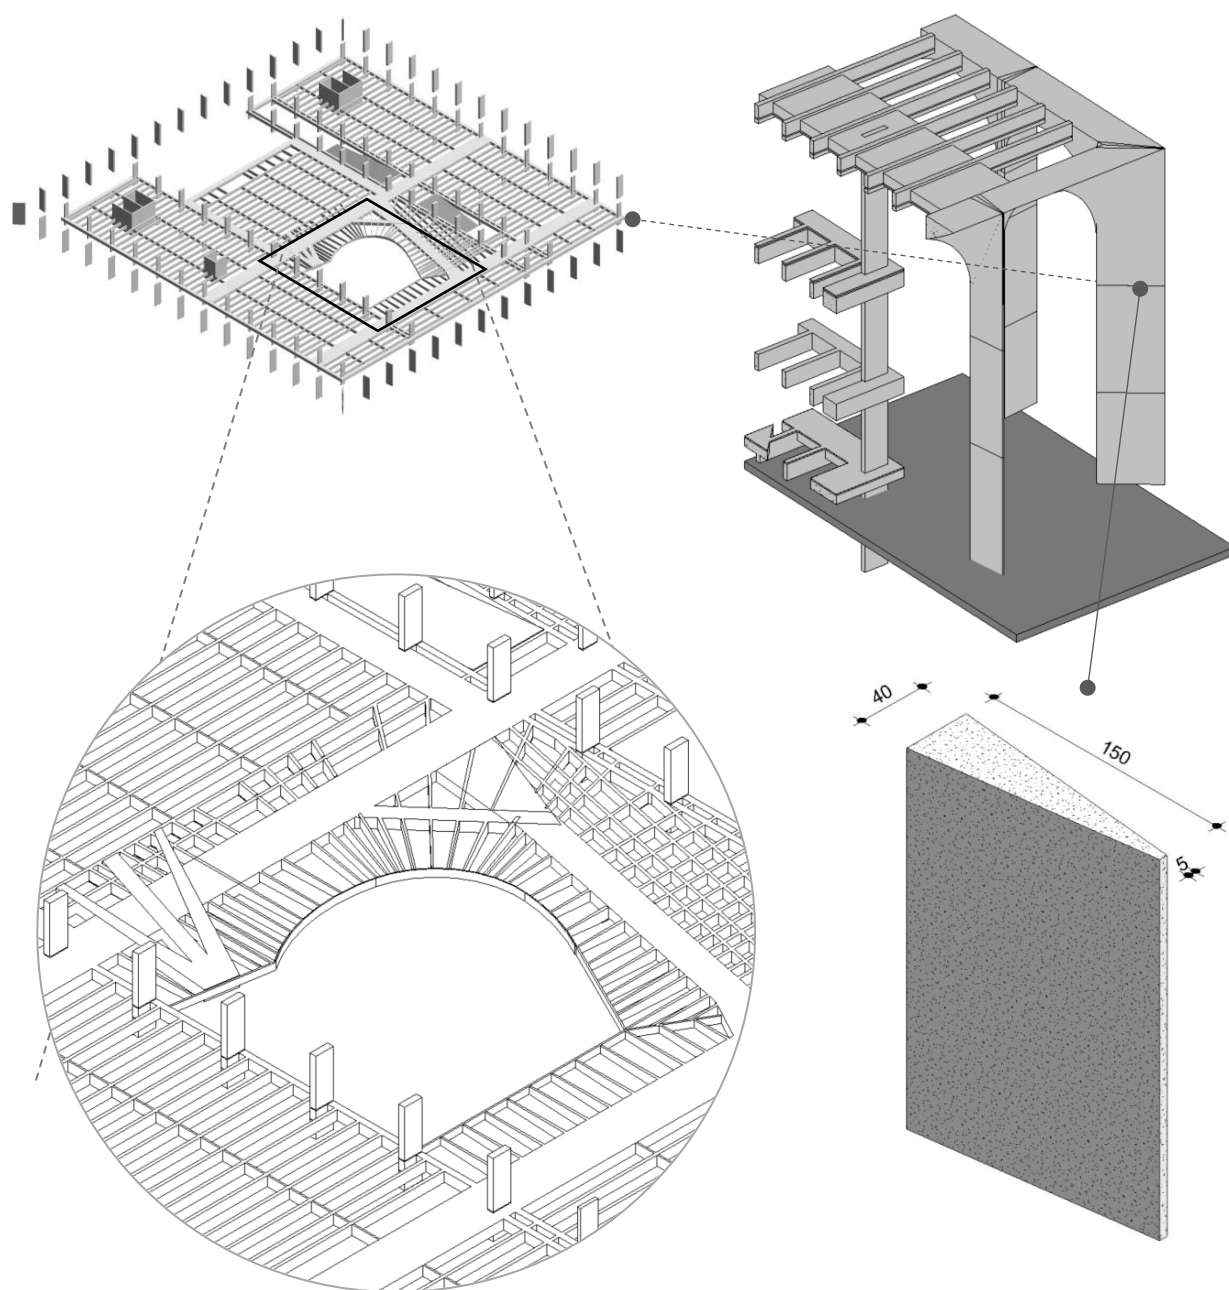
Detalhe do segundo plano de laje e pilar externo trapezoidal
